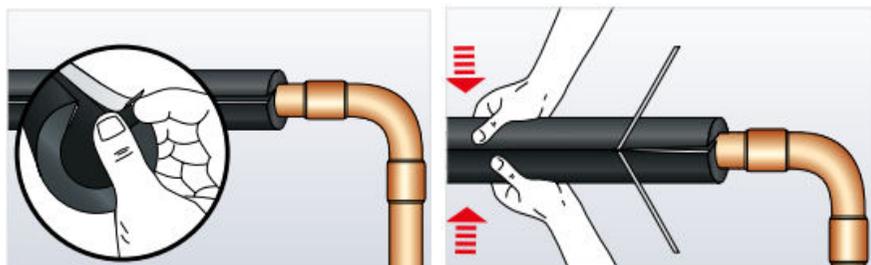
Détacher le film protecteur et presser les plans de joint l'un contre l'autre
